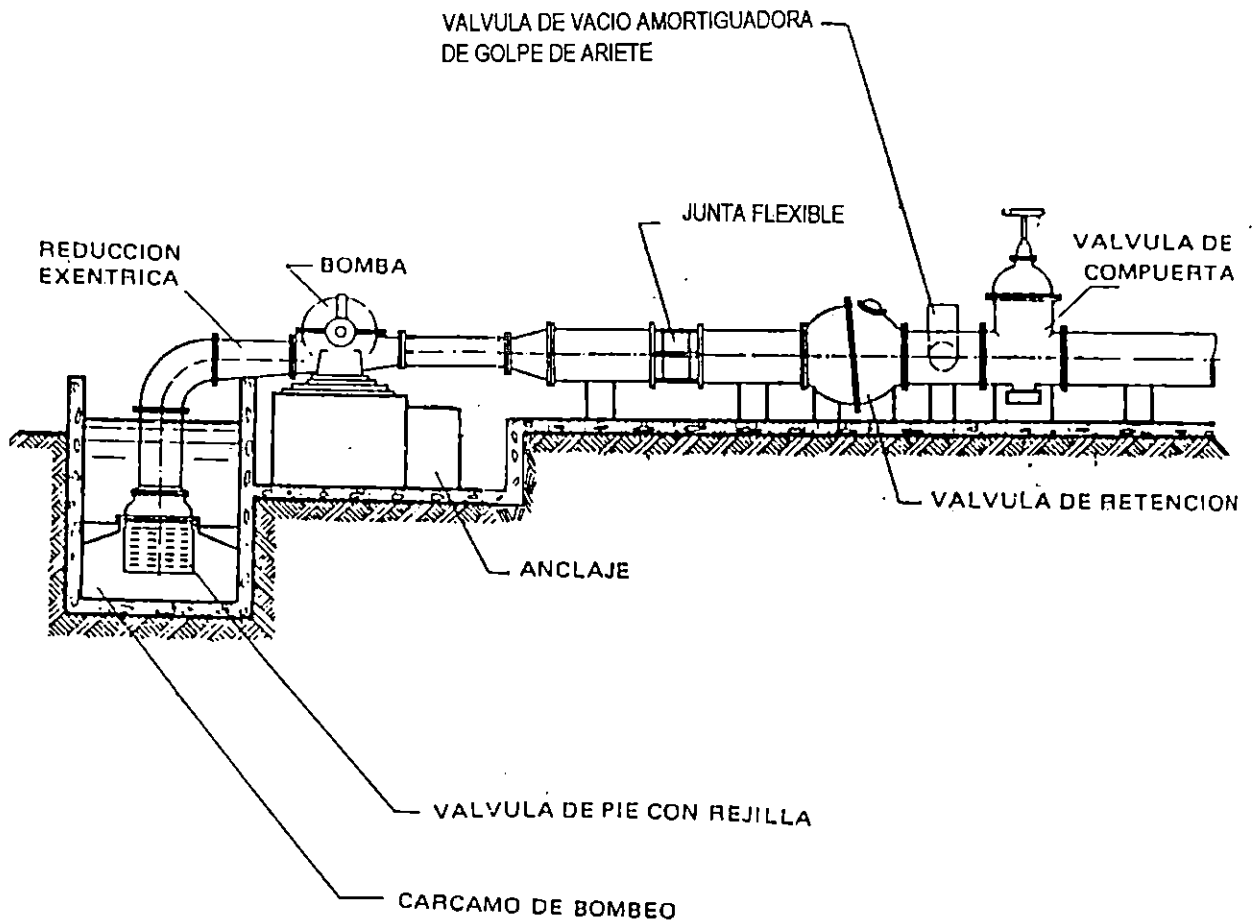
Esquema de montaje de un Equipo de Bombeo
